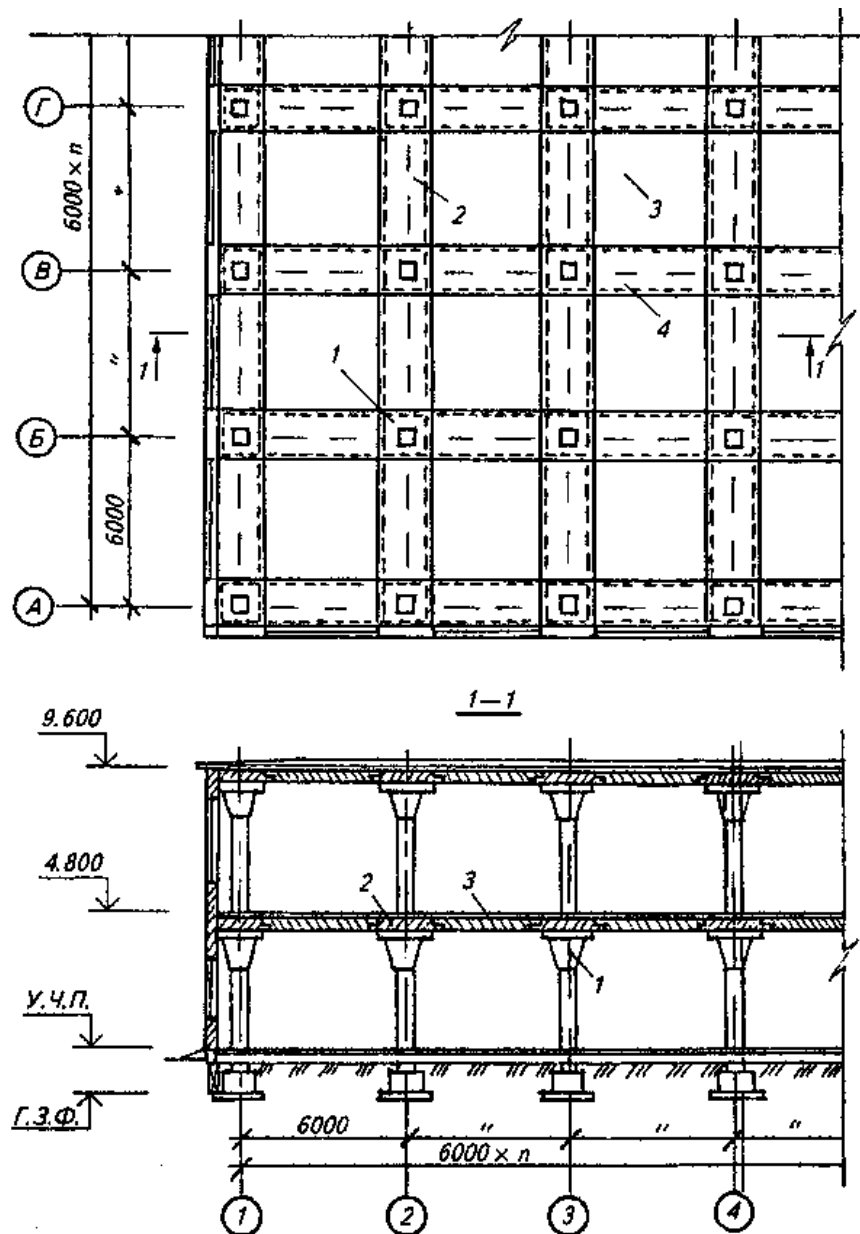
Безбалочные перекрытия: 1 – колонна с оголовком капитель; 2 – надколонные панели; 3 – рядные панели; 4 – пролетная плита
